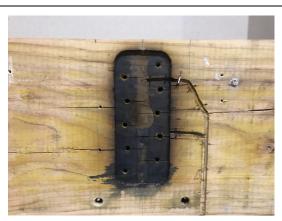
試験体 1-1 耐火構造壁内の梁(ベイマツ製材)表面
